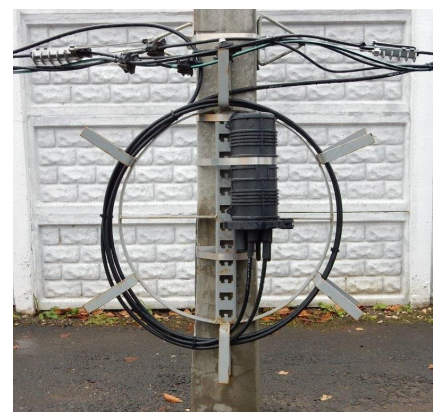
Вариант исполнения монтажа оптической муфты на проводе СИП-2/О с соединением жил в шлейфе опоры
